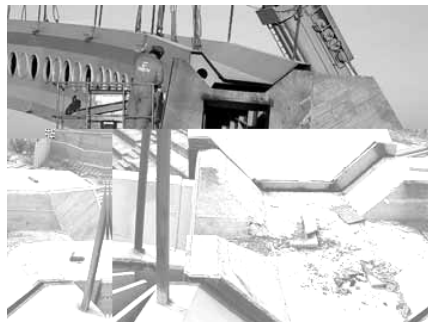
Soldadura de las vigas a los soportes.
